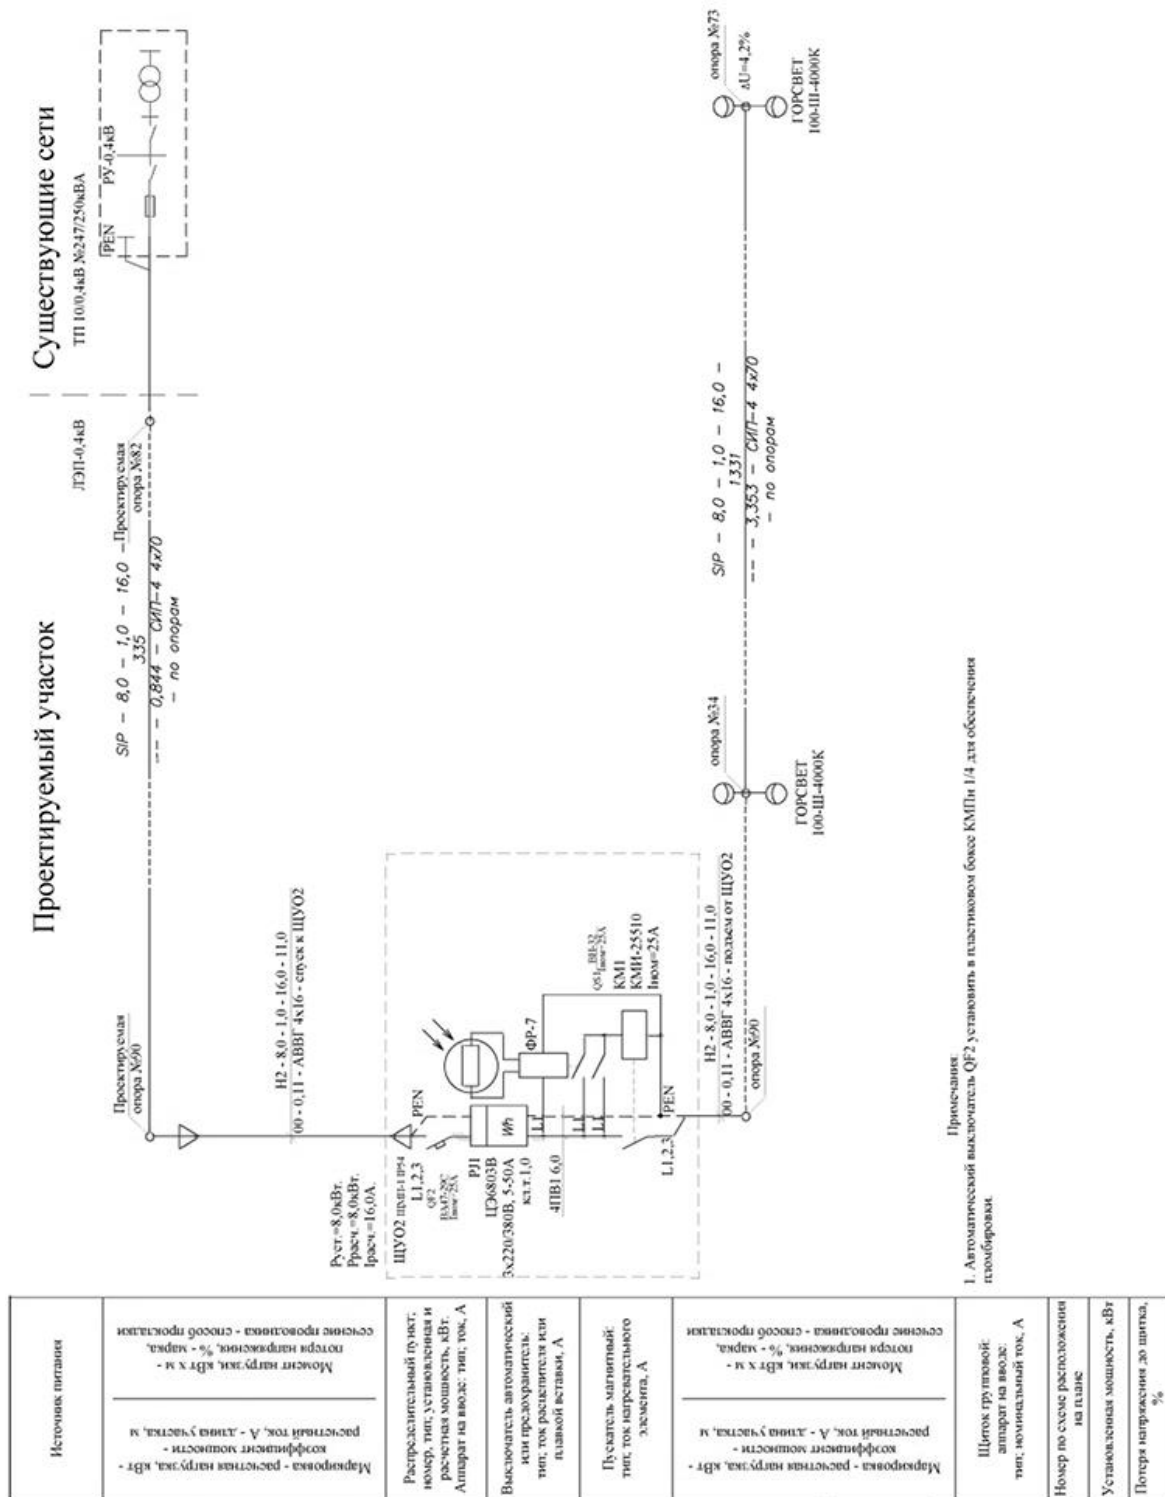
Расчетная схема наружного освещения ЩУО2
